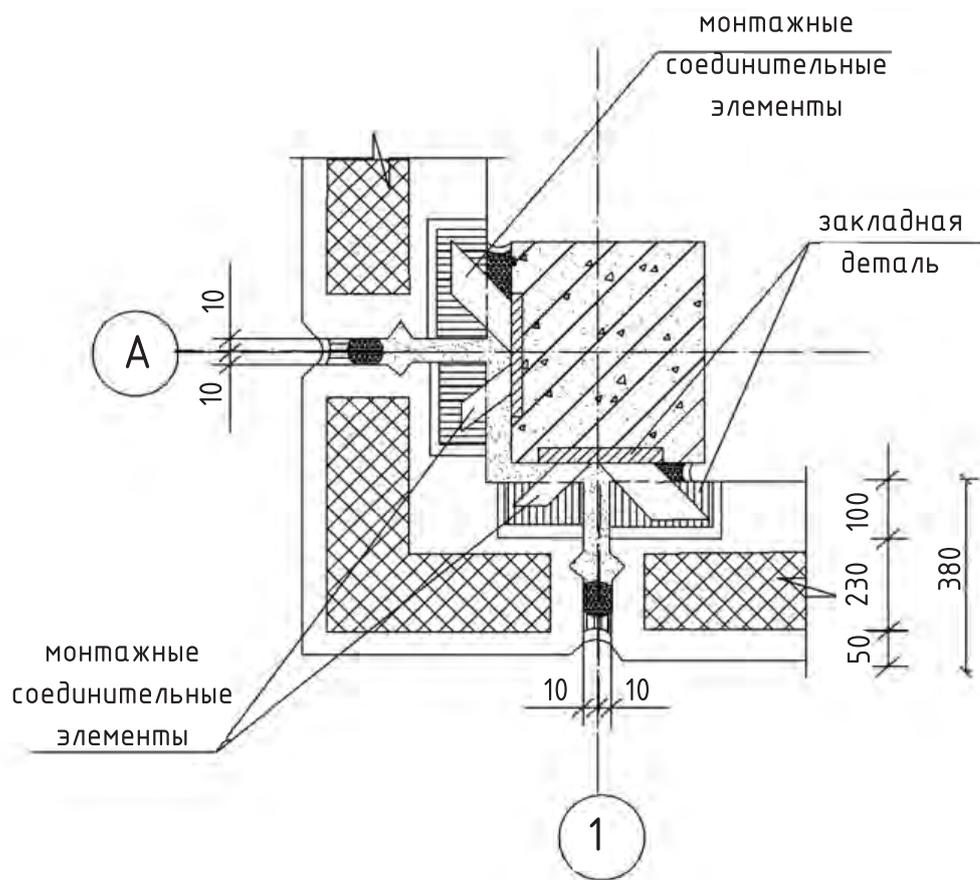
Вертикальный угловой стык колонны с наружными стеновыми панелями
